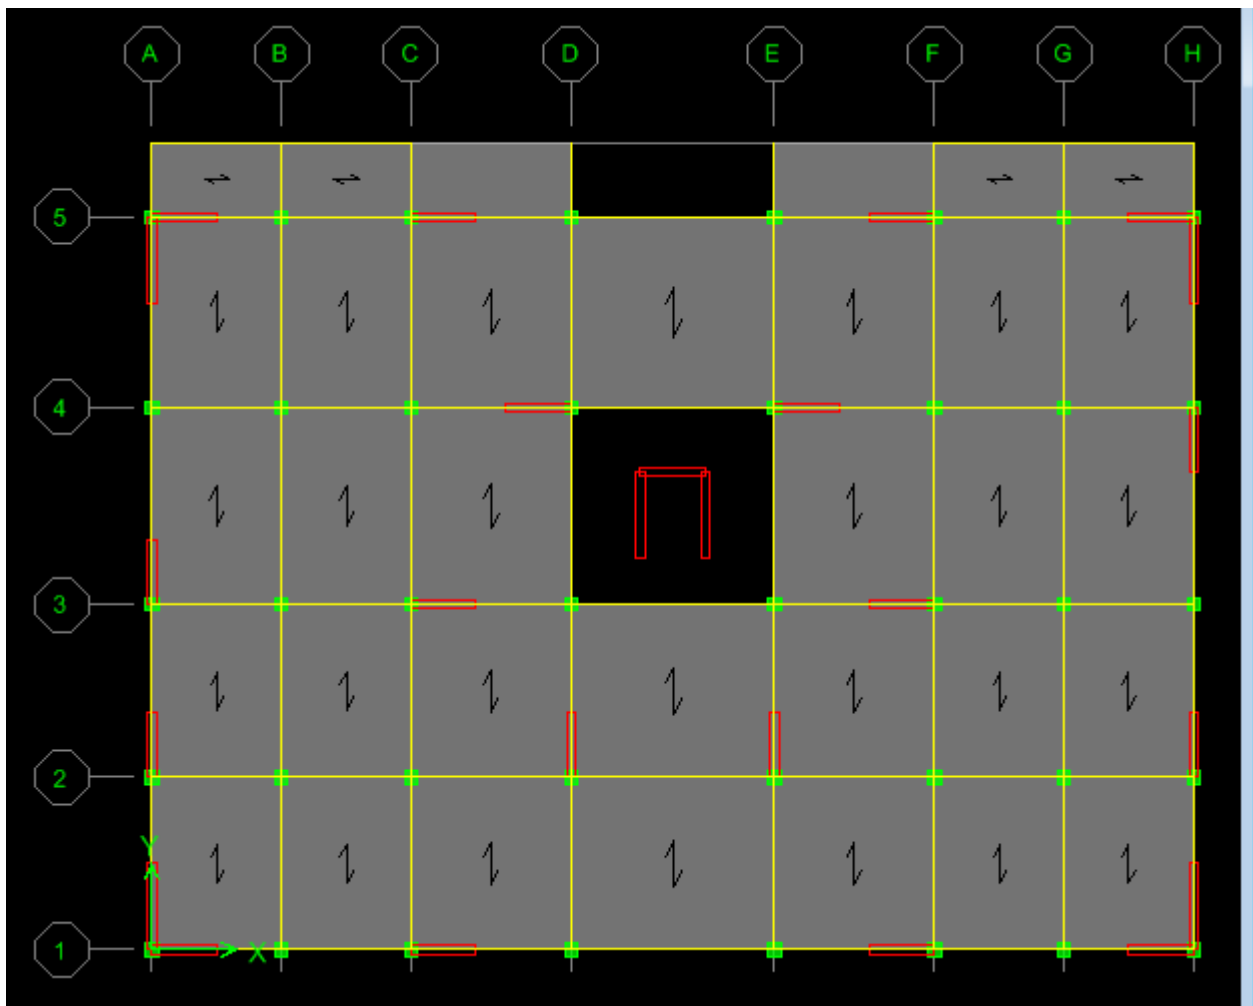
Vue en plan des éléments structuraux d'un étage.
